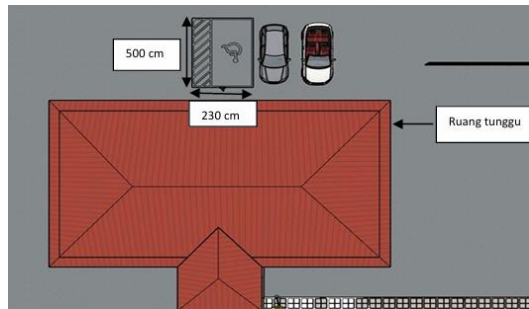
46 Rencana Pembangunan Toilet Disabilitas di Ruang Tunggu
